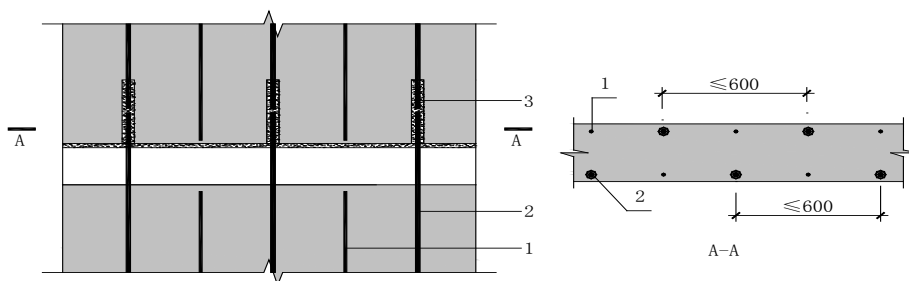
预制剪力墙竖向分布钢筋连接构造示意
